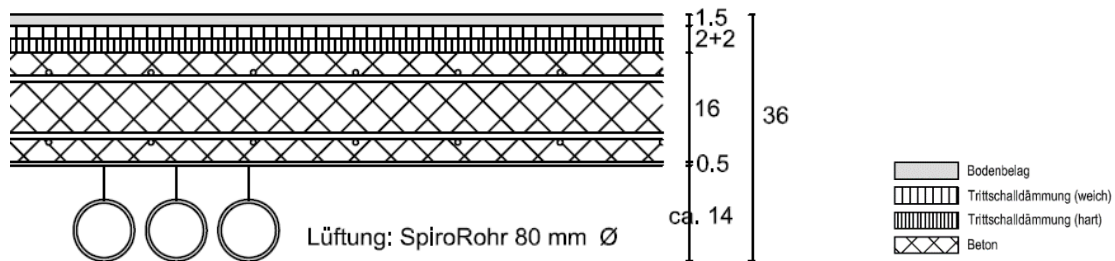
Querschnitt Zusatzvariante 5 «Leitungen sichtbar geführt, Betondecke nach Statik dimensioniert (16 cm)» ohne Unterlagsboden
